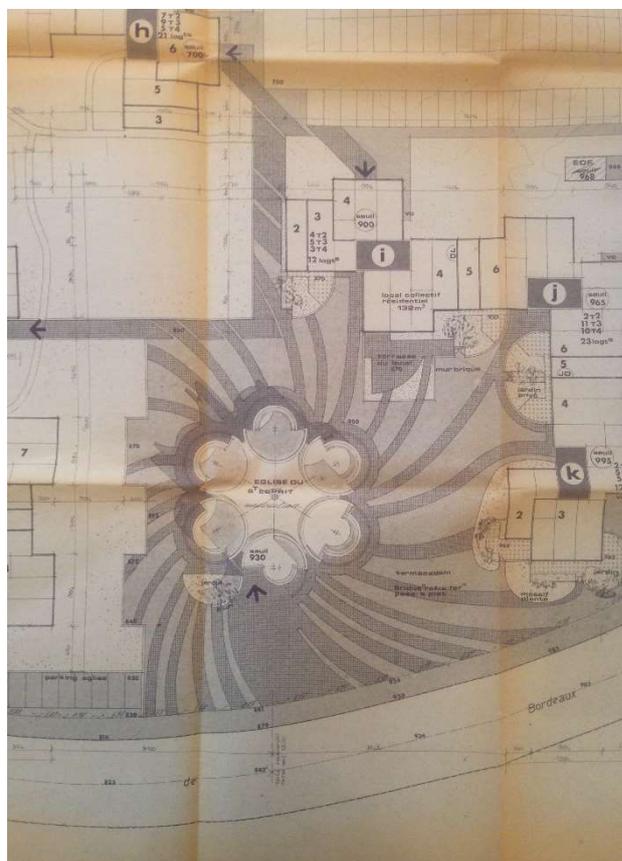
Plan masse avec épannelage du traitement de sol, sept 1975.
